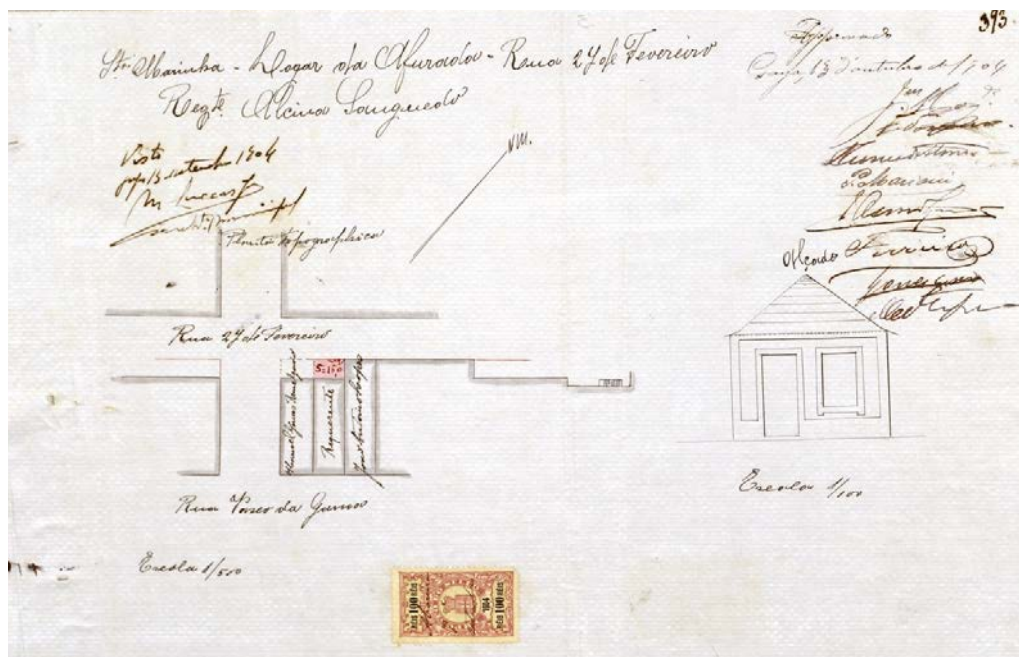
Alzado de vivienda de planta baja en la Rua 27 de Fevereiro, Afurada de Baixo, 1904. [Fuente: "Pedido de alineamientos de calles", Arquivo Municipal Sophia de Mello Breyner]
